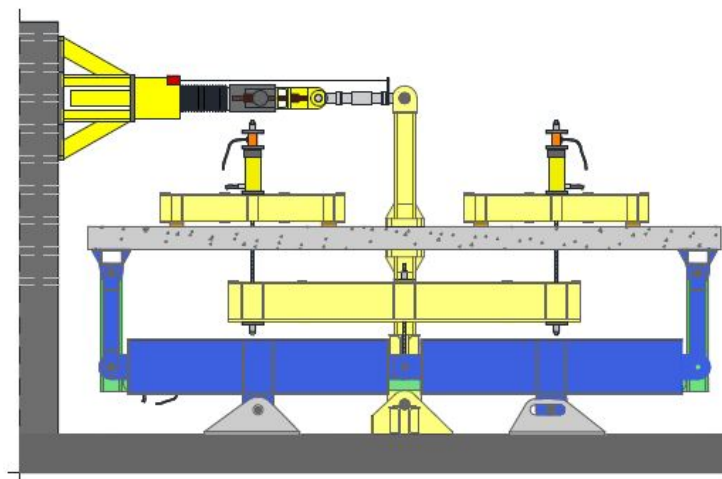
Sistema de ensaio em alçado (adaptado de [9])
